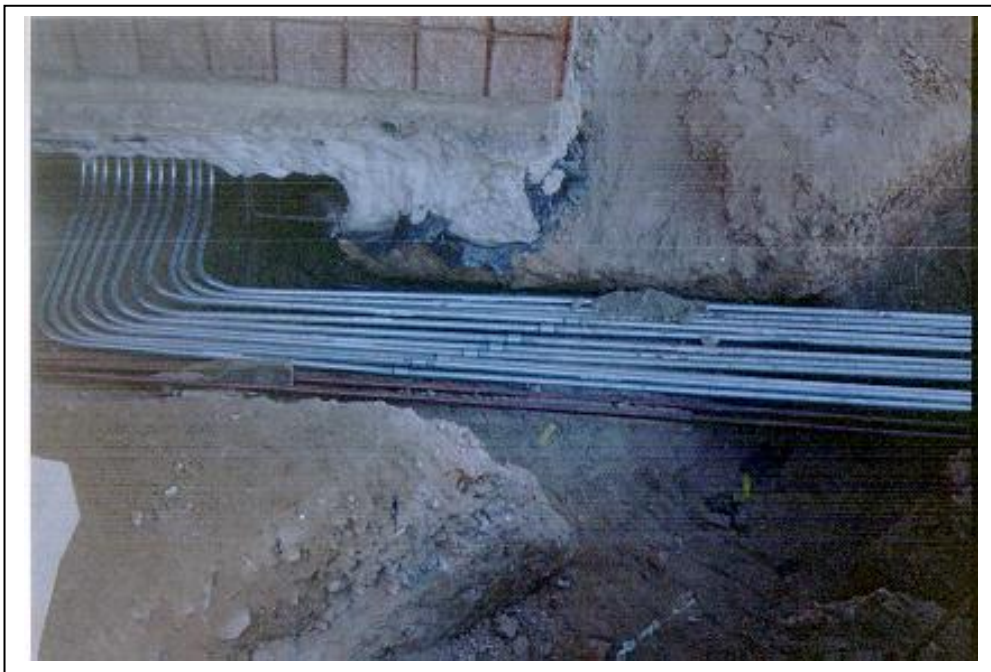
Tubería Conduit cédula 40 a prueba de explosión para la instalación eléctrica
